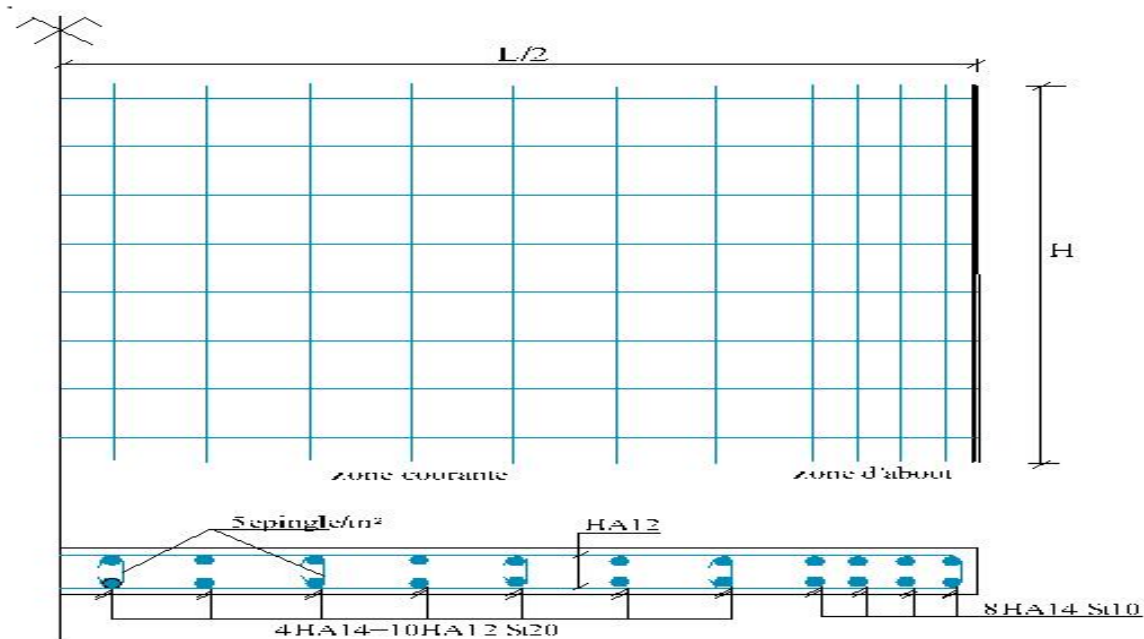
Disposition constructive des armatures des voiles pleins.
